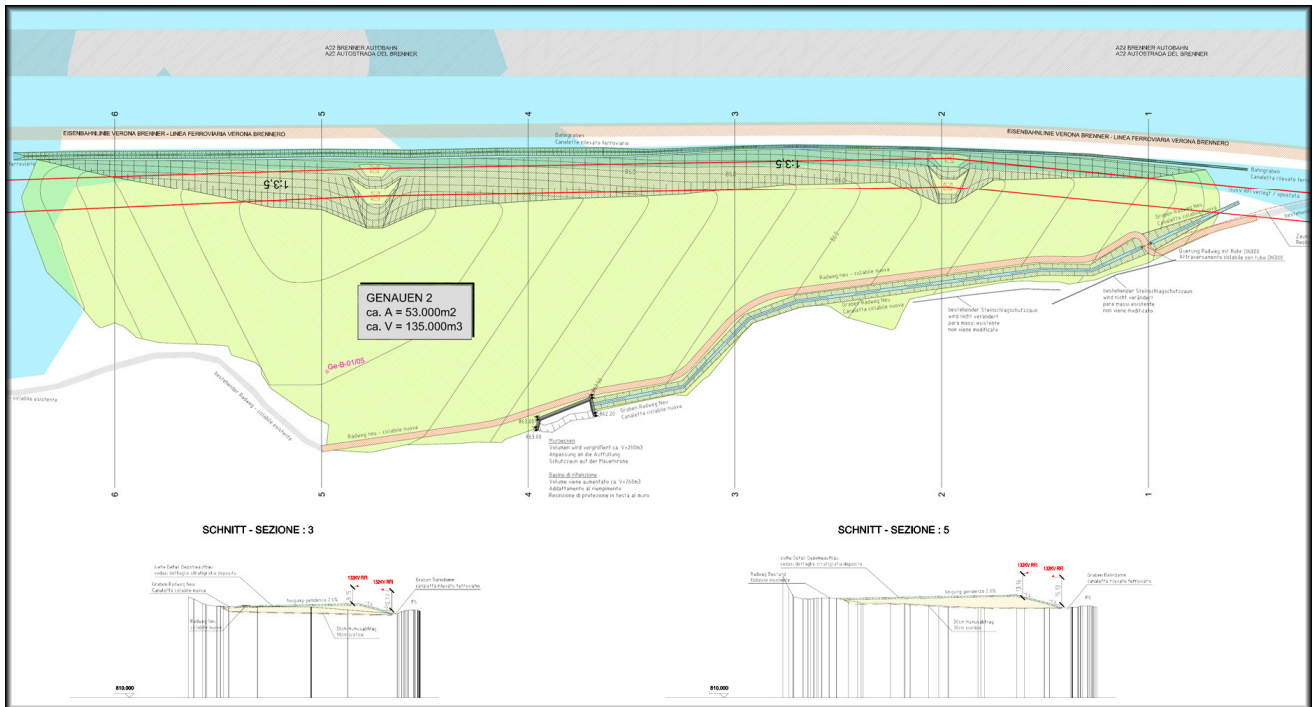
Lageplan und regelquerschnitt deponie Genauen 2
